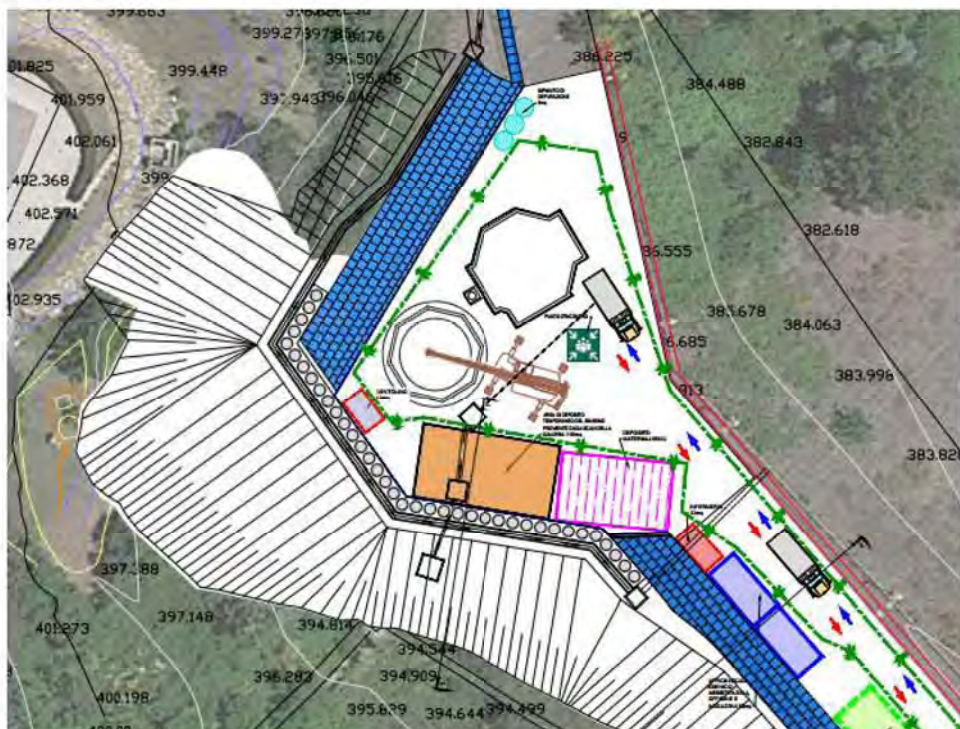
Area di Deposito Temporaneo delle TRS – Area di cantiere Pozzo di servizio
